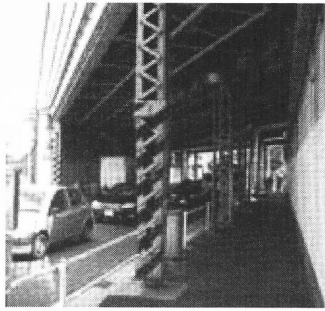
ポスト形式の鋼橋脚を有する鉄道橋の例
